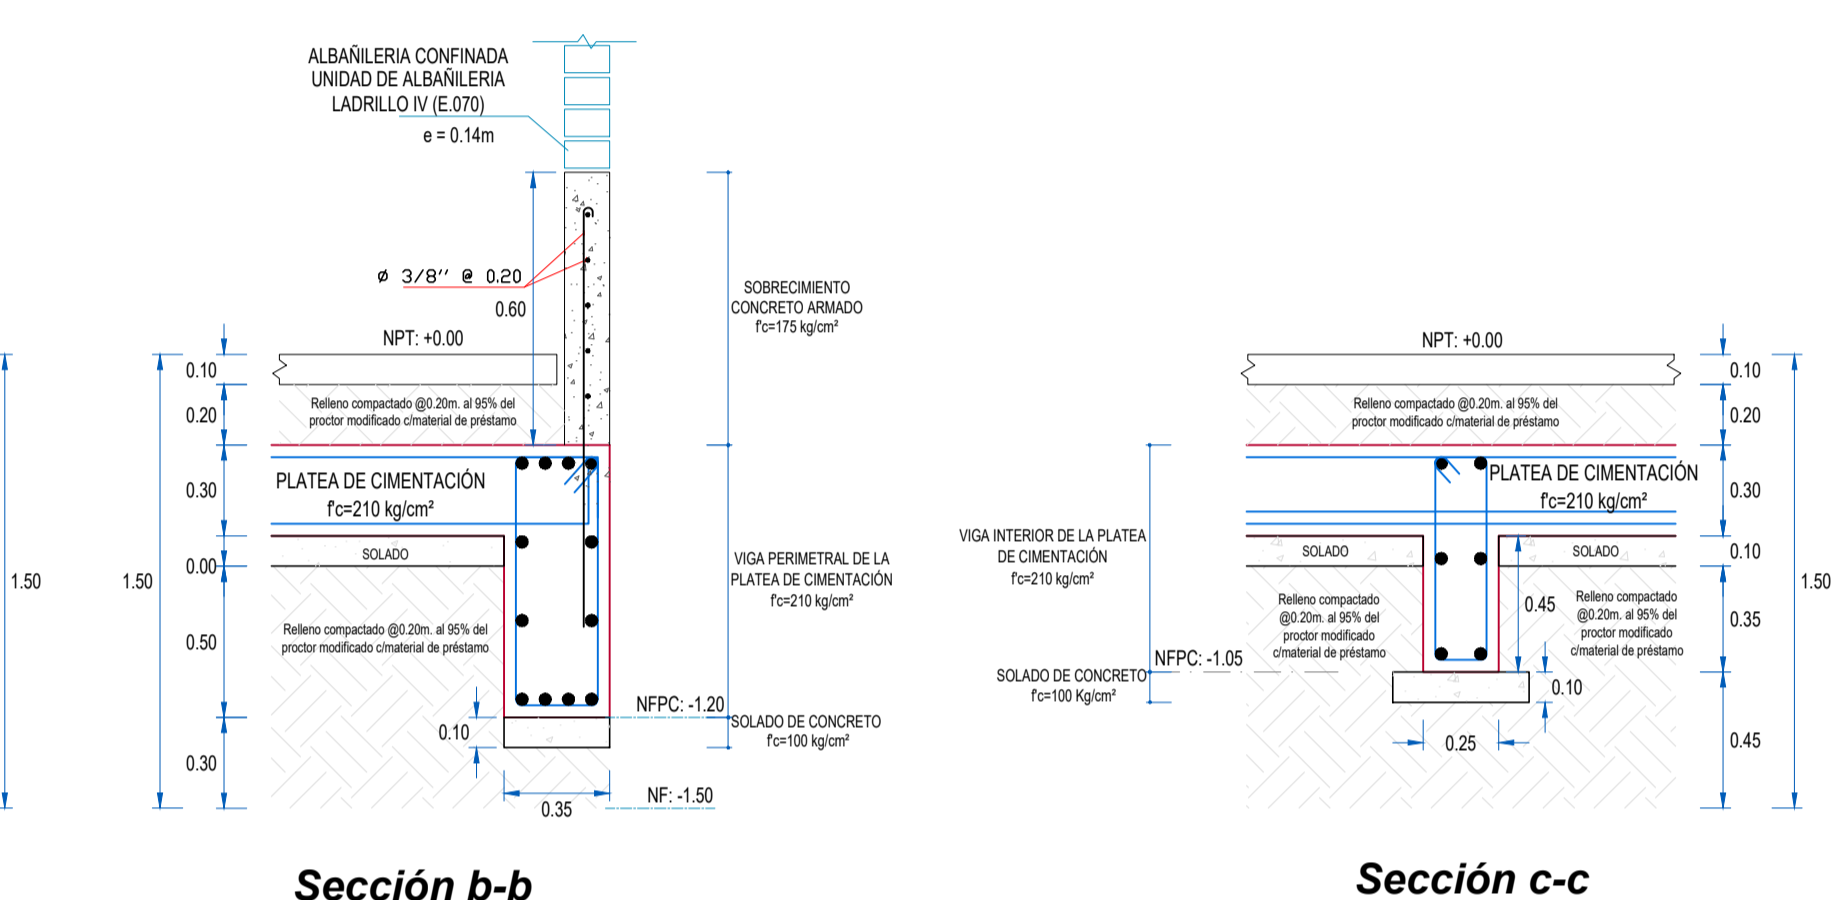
PLATEA DE CIMENTACIÓN (CORTE 2-2)
